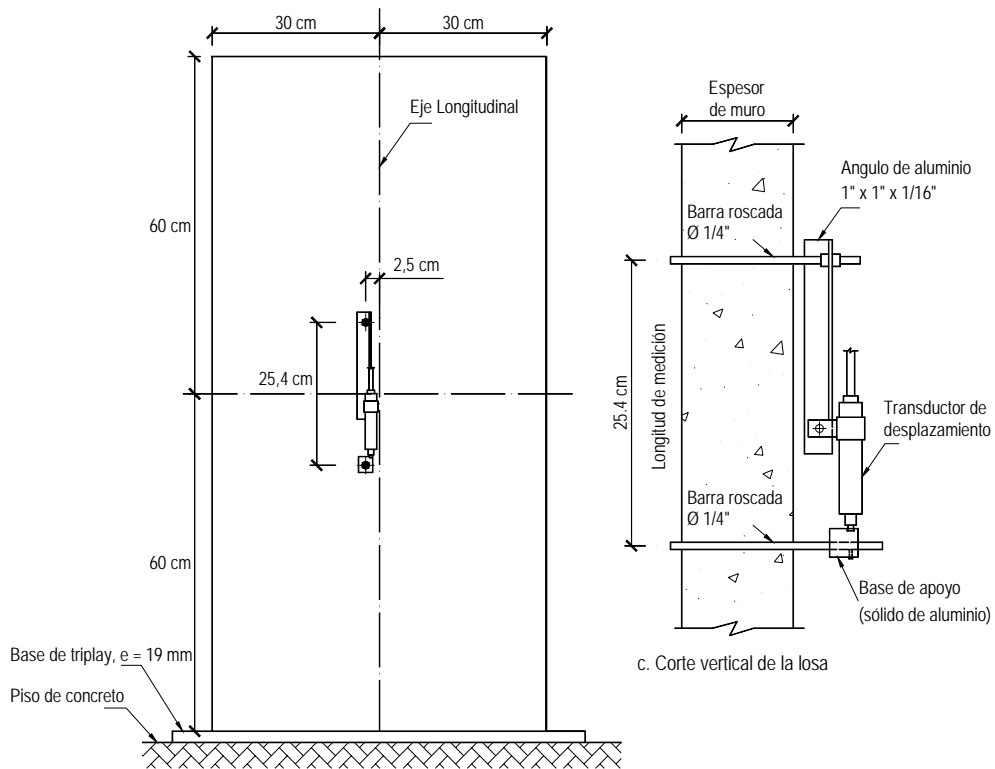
Ubicación de los deformímetros para acero y para concreto
